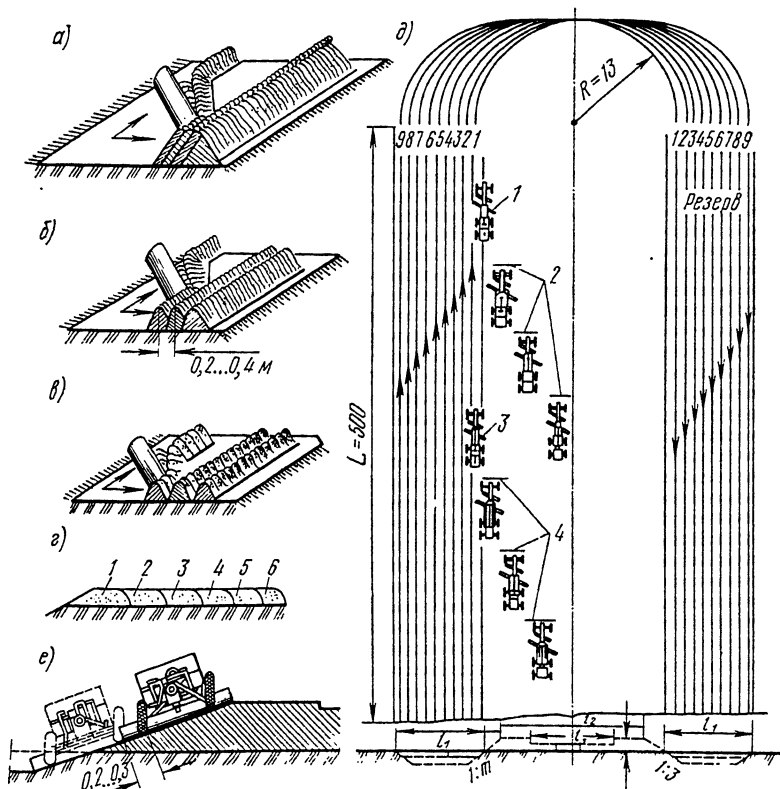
Способы укладки грунта в тело насыпи (размеры в м):
